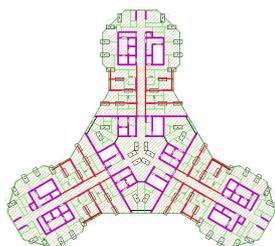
Схема с продольным и поперечным расположением дополнительных жесткостей
